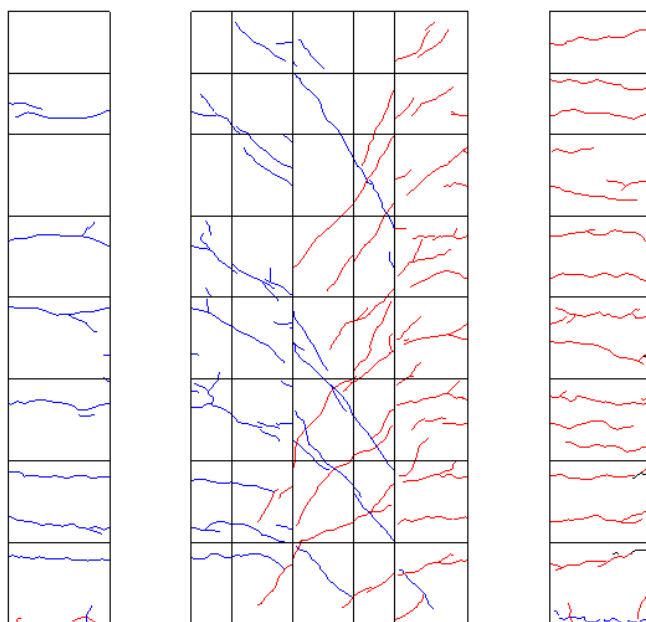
R=1/100②ひび割れ図
